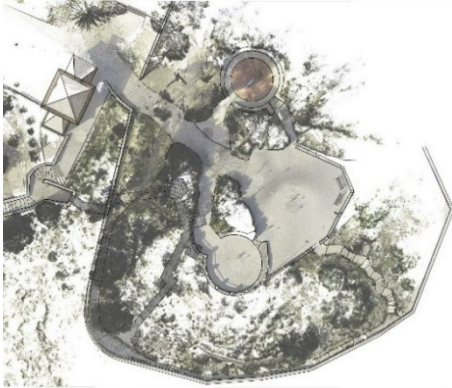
Ubicación de la batería y las galerías subterráneas en la plaza. (Proyecto de restauración y puesta en valor, 2022).
